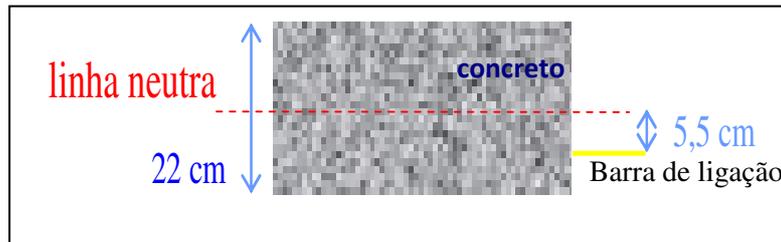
Barra de ligação a ¼ da altura da placa de concreto.
